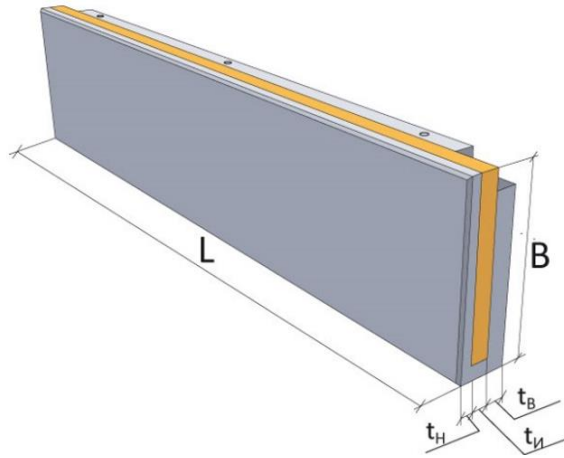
Прийняті стінові залізобетонні панелі
